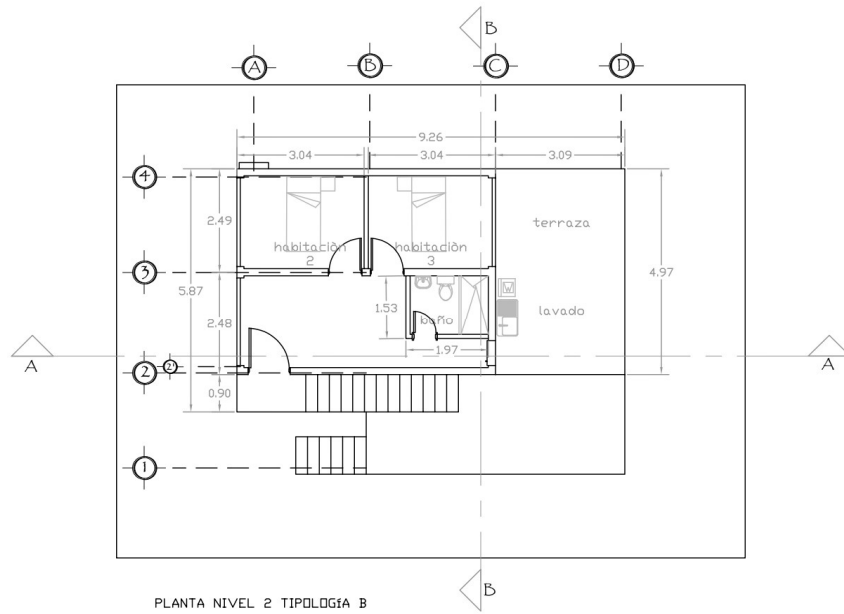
Planta Segundo Nivel Tipología - B - Elaboración propia
